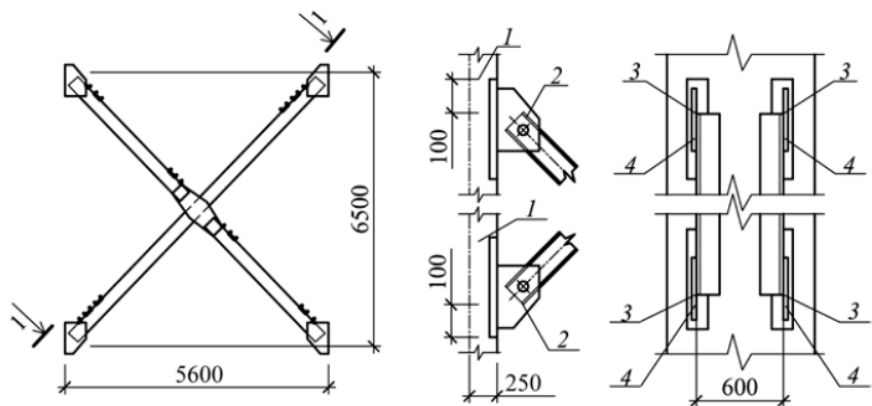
Кріплення хрестового зв'язку до колони: 1 – колона; 2 – вертикальний зв'язок; 3 – закладні сталеві деталі; 4 – зварювання
